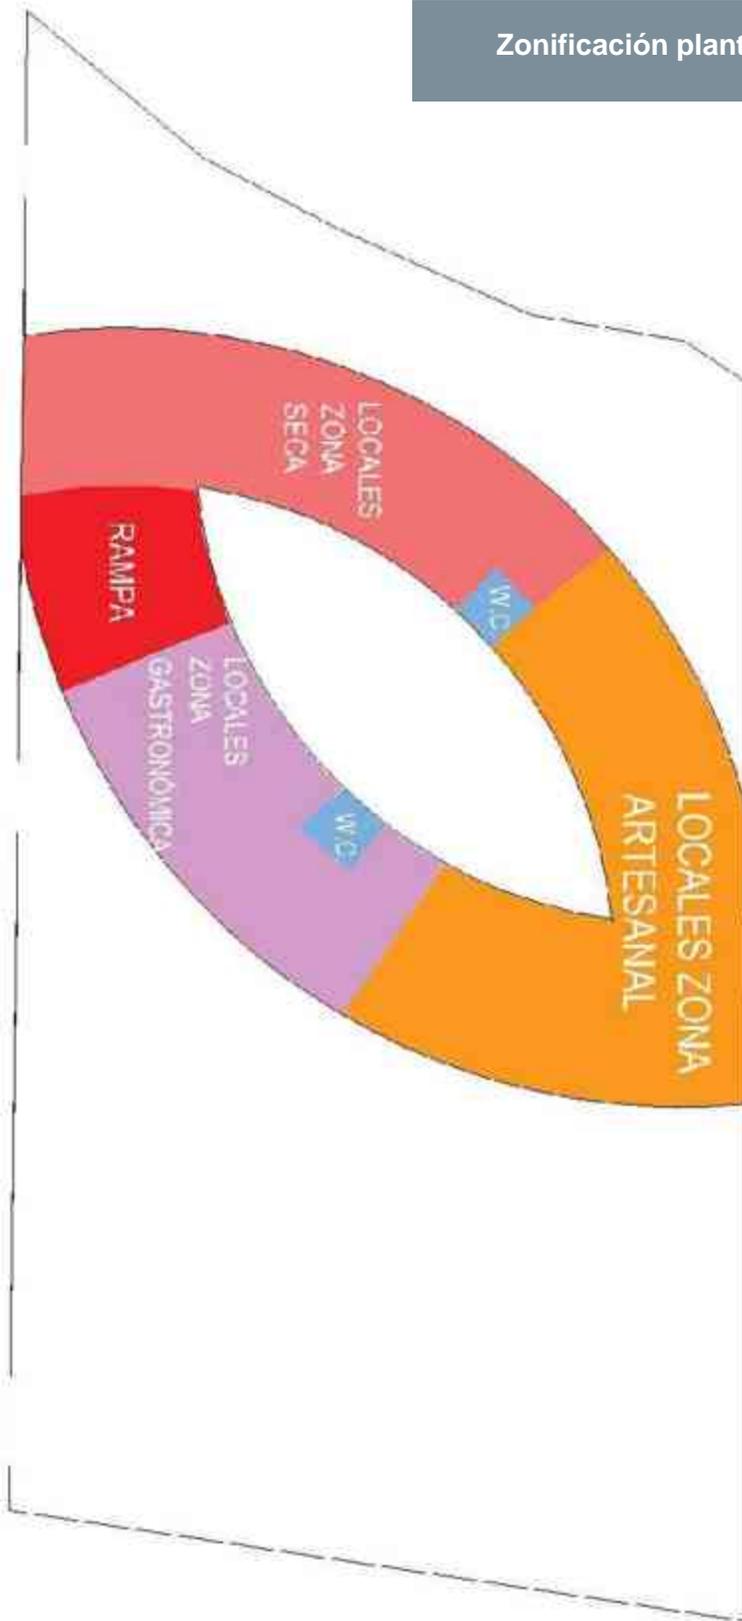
Zonificación de Planta Alta. Fuente: Autor.
